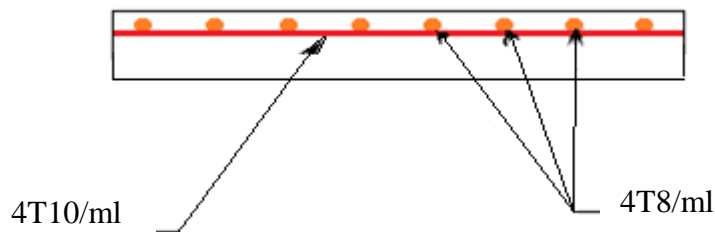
Schéma de ferrailage de la dalle sur deux appuis.
